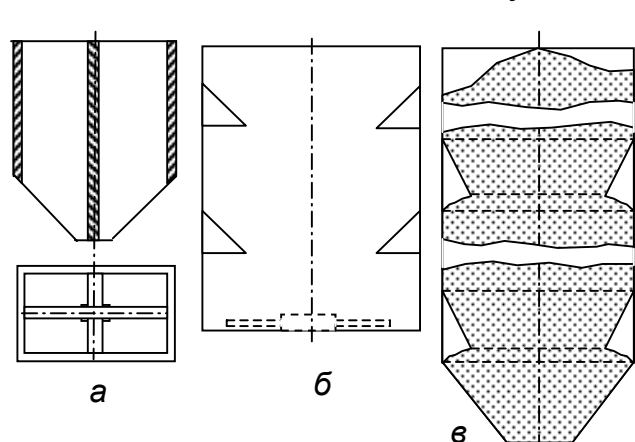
Конструктивные схемы бунке- ров стабилизаторами давления
